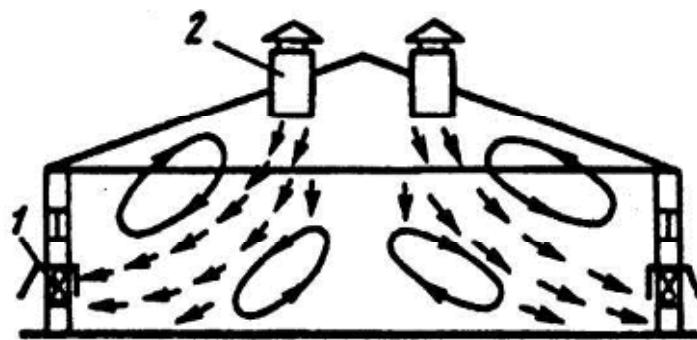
Вытяжная вентиляция с настенными вентиляторами: 1 - настенные вентиляторы; 2 - приточные шахты.
